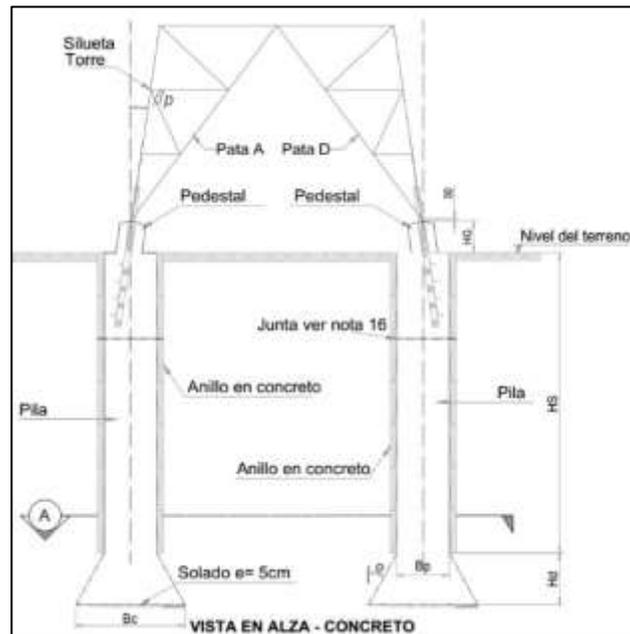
Esquema general típico para la cimentación tipo pila sumergida
